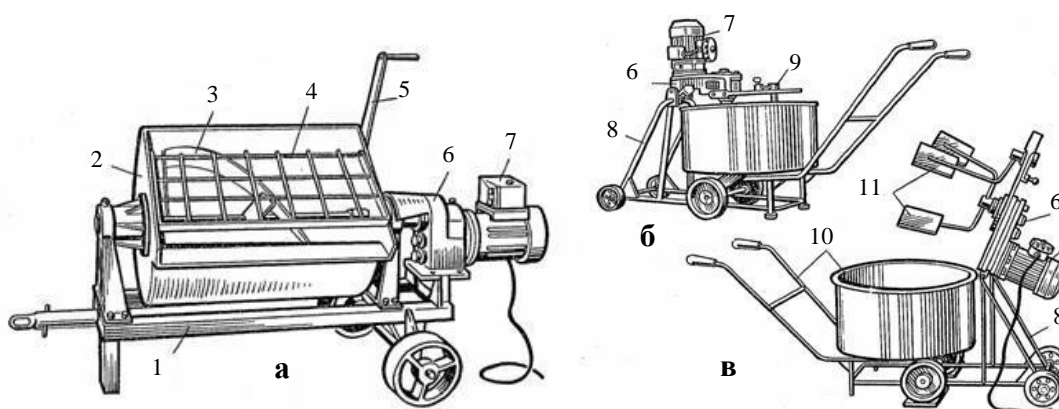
Розчинозмішувачі: а – СО-46Б, б – СО-238 з відкидними лопатами в робочому положенні, в – СО-238 з відкидними лопатами в неробочому положенні; 1 – візок; 2 – змішувальний барабан; 3 – лопатний вал; 5 – ручка; 6 – редуктор; 7 – електродвигун; 8 – рама; 9 – опущені лопаті; 10 – тачка з бункером; 11 – лопаті
